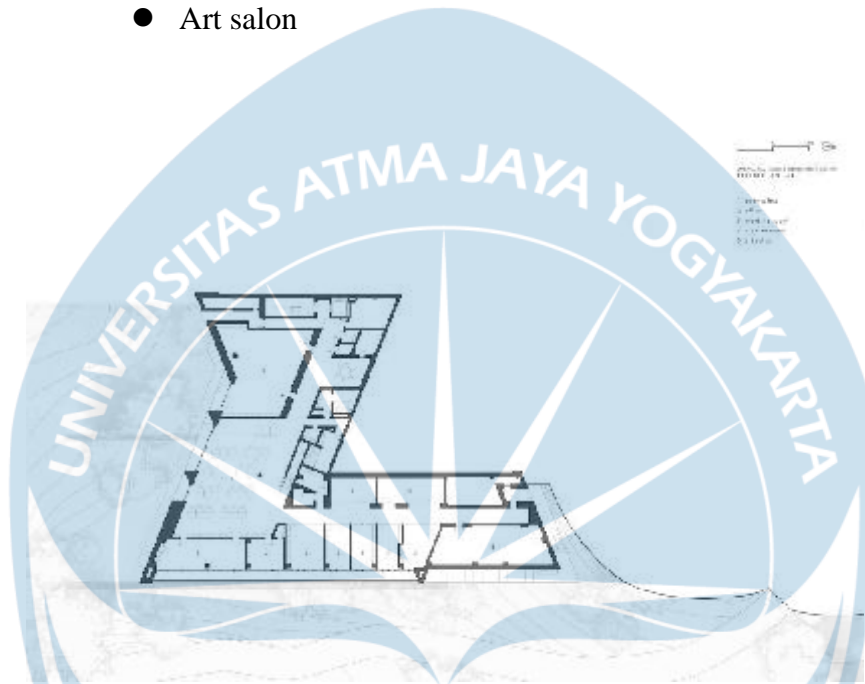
15 Denah Basement 1 Dafa Canal Information Center
